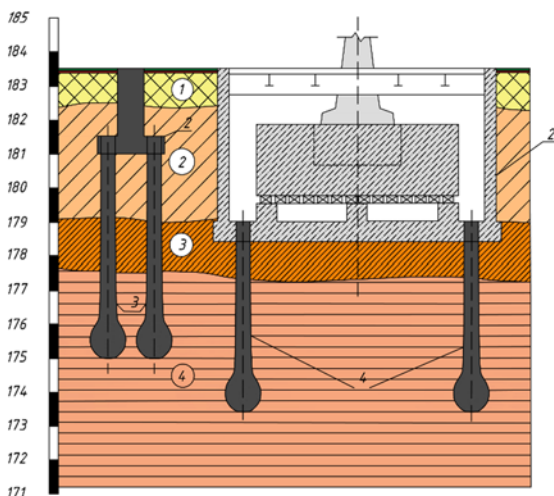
Инженерно-геологический разрез: 1 – фундамент каркаса здания; 2 – фундамент кузнечно-штамповочного молота; 3 – буринъекционные сваи ЭРТ (РИТ, ФОРСТ, ЭРСТ) усиления основания фундаментов каркаса; 4 – буринъекционные сваи ЭРТ (РИТ, ФОРСТ, ЭРСТ) усиления основания фундаментов кузнечных молотов; 1 – насыпной слой; 2 – суглиной тугопластичный; 3 – суглинок мягкопластичный; 4 – глина алевритистая тугопластичная
